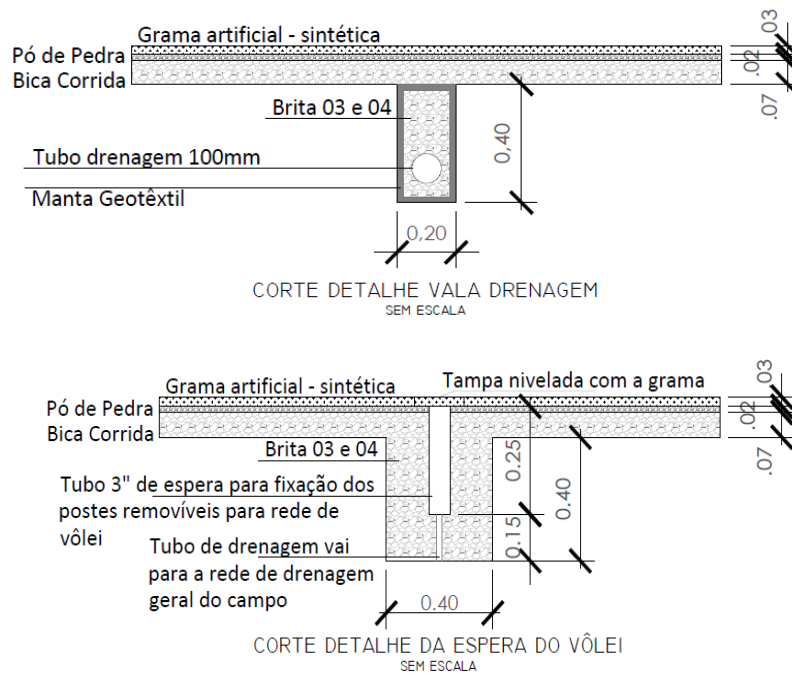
Detalhe da drenagem para tubo de espera da estrutura de vôlei (Fonte: Autora/2022)
